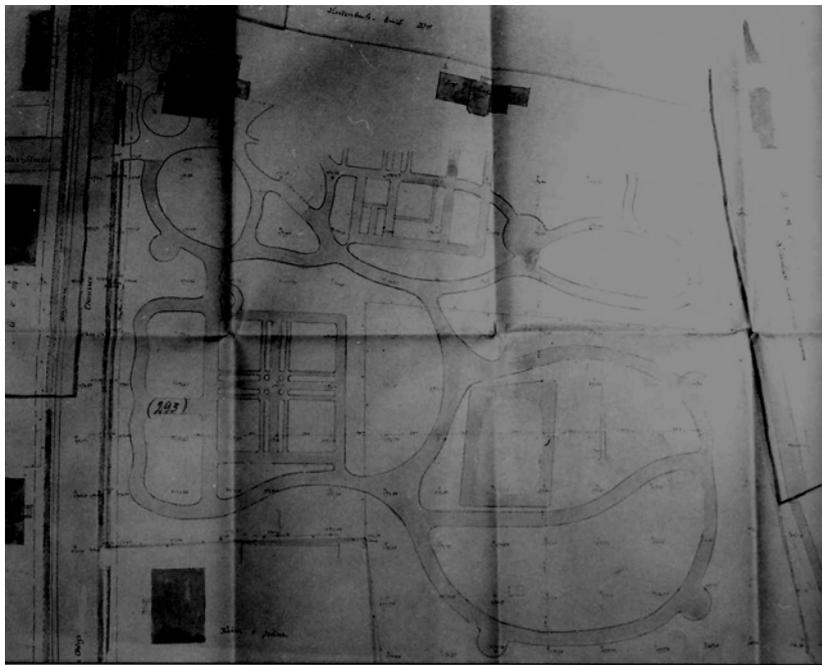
Grundstücksplan mit projektiertem Neubau und Parkanlage vom 06.09.1907
